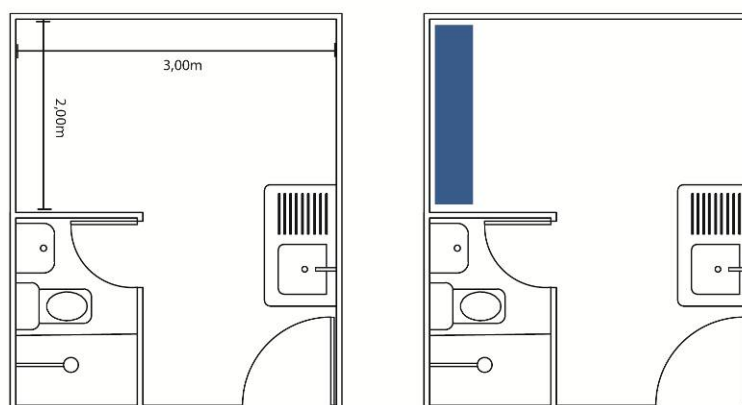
Planta de um módulo e espaço disponível para estante de sala.
